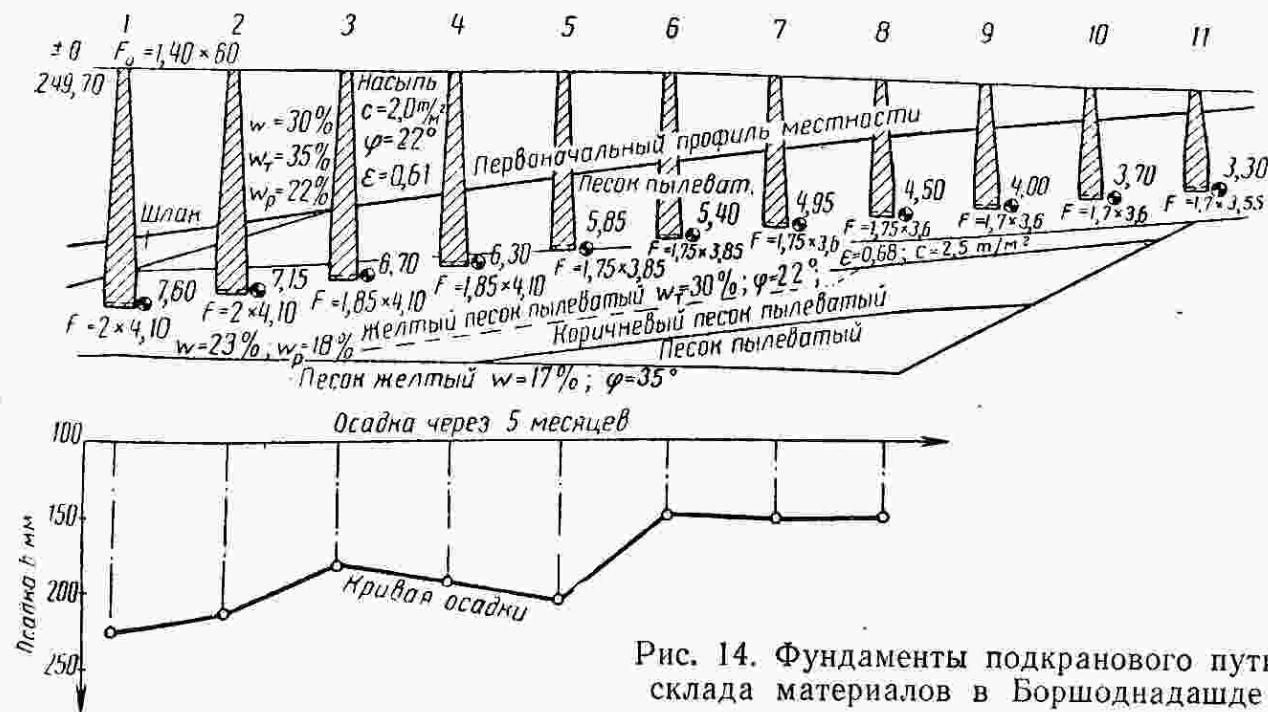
Фундаменты подкранового пути склада материалов в Боршоднадашде
